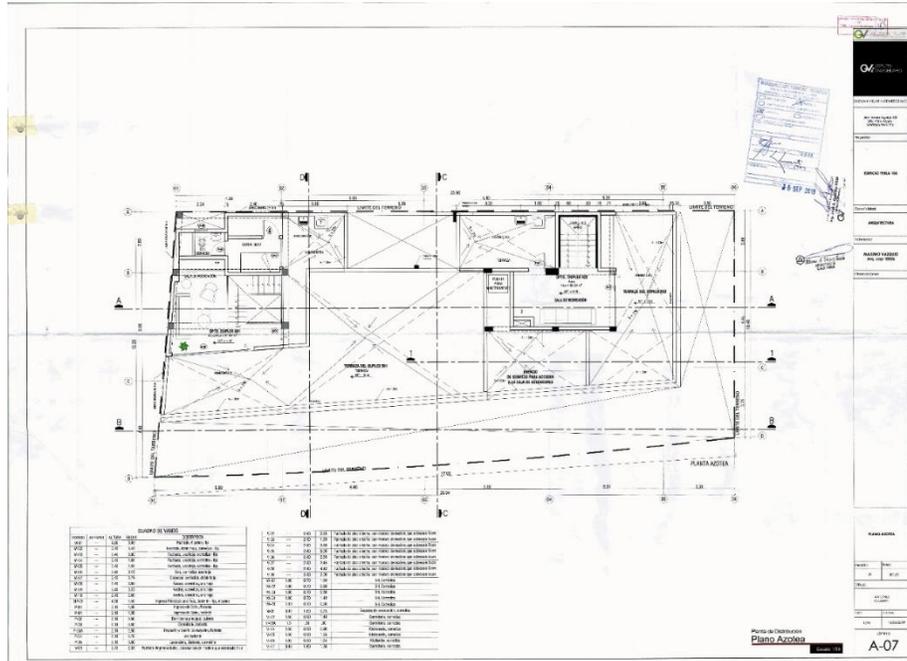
Plano de tercer nivel proyecto Perla103.)
